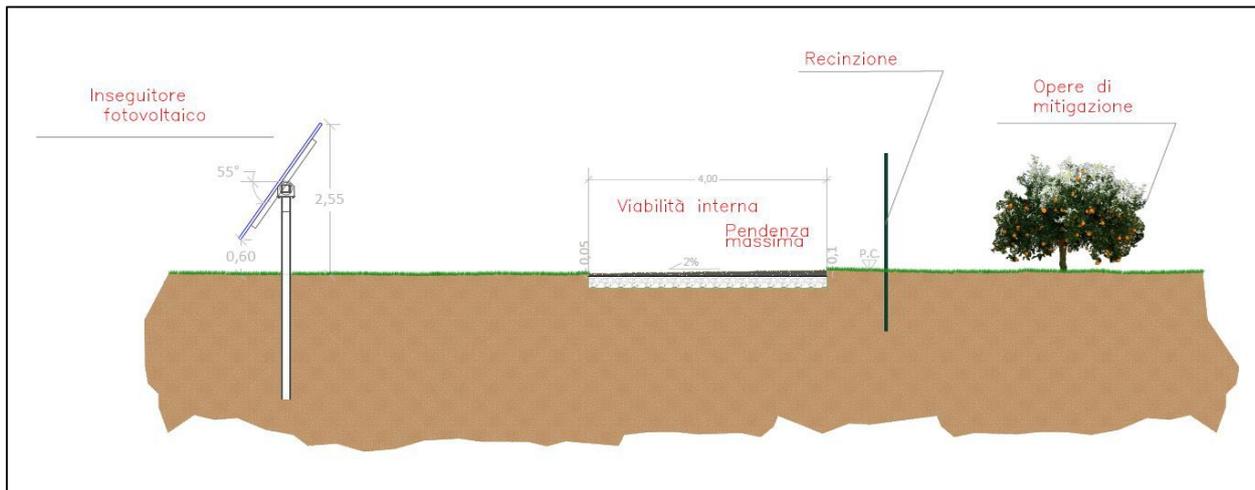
Schema della fascia di rispetto con recinzione ed elementi arborei.
